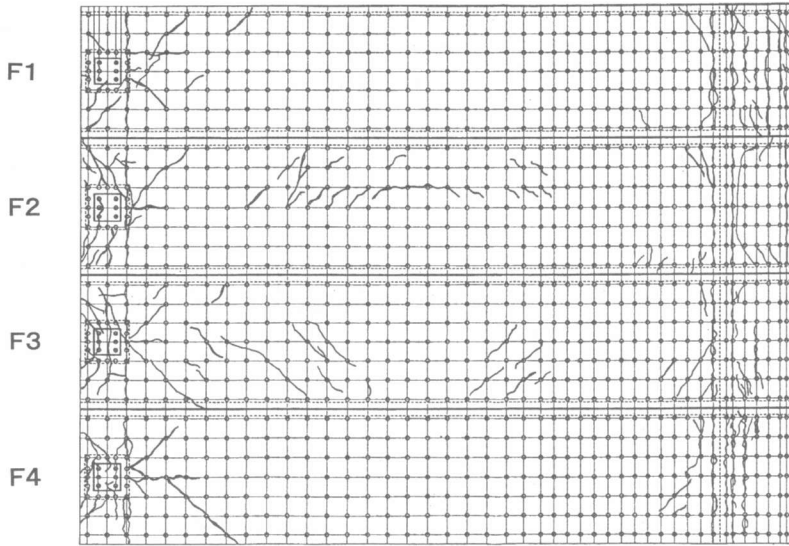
実験後の内部コンクリートひび割れ展開図
